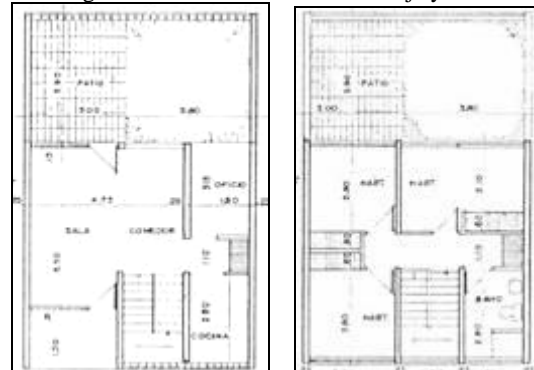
h. Casa CMD3B. Plantas Baja y Alta (1952)
